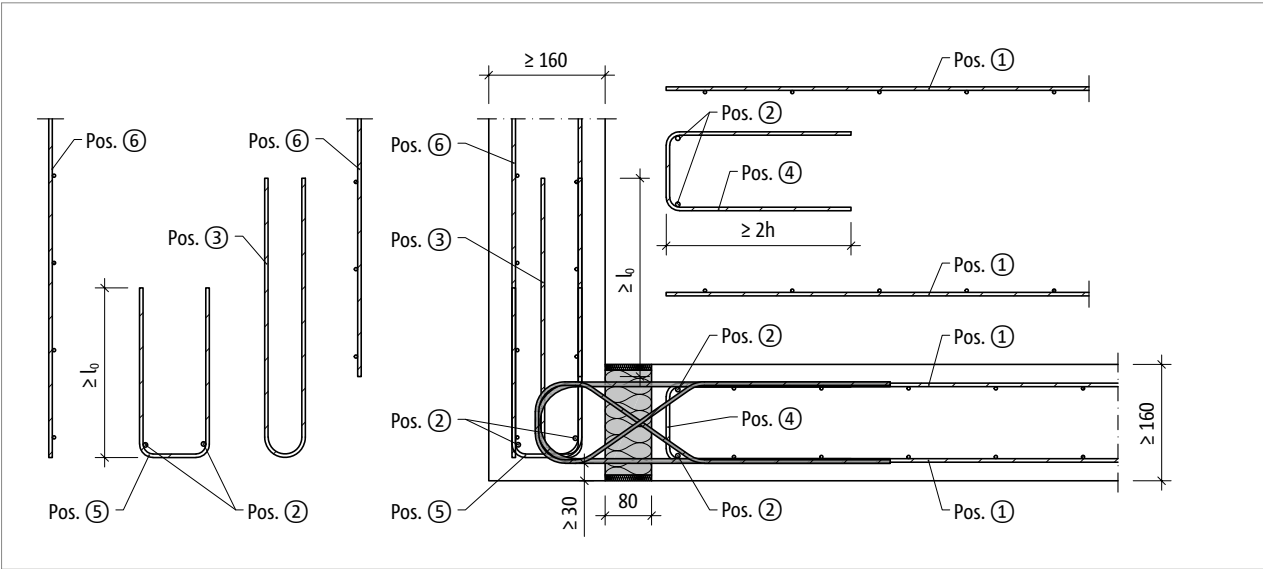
Schöck Isokorb® T type A disposition horizontale : Renforcement sur site
